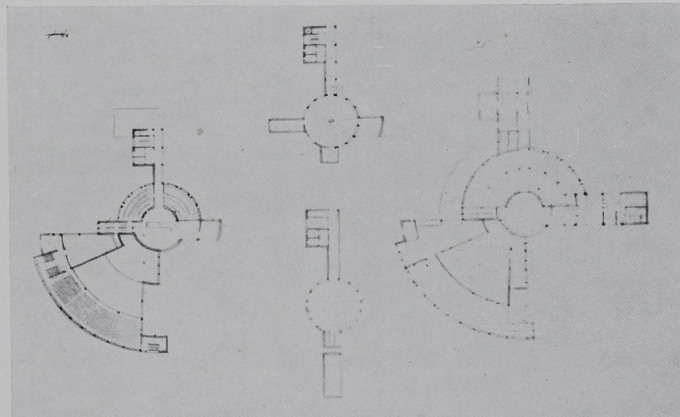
I. Lamzow, Entwurf für einen Klub. Grundrisse.
